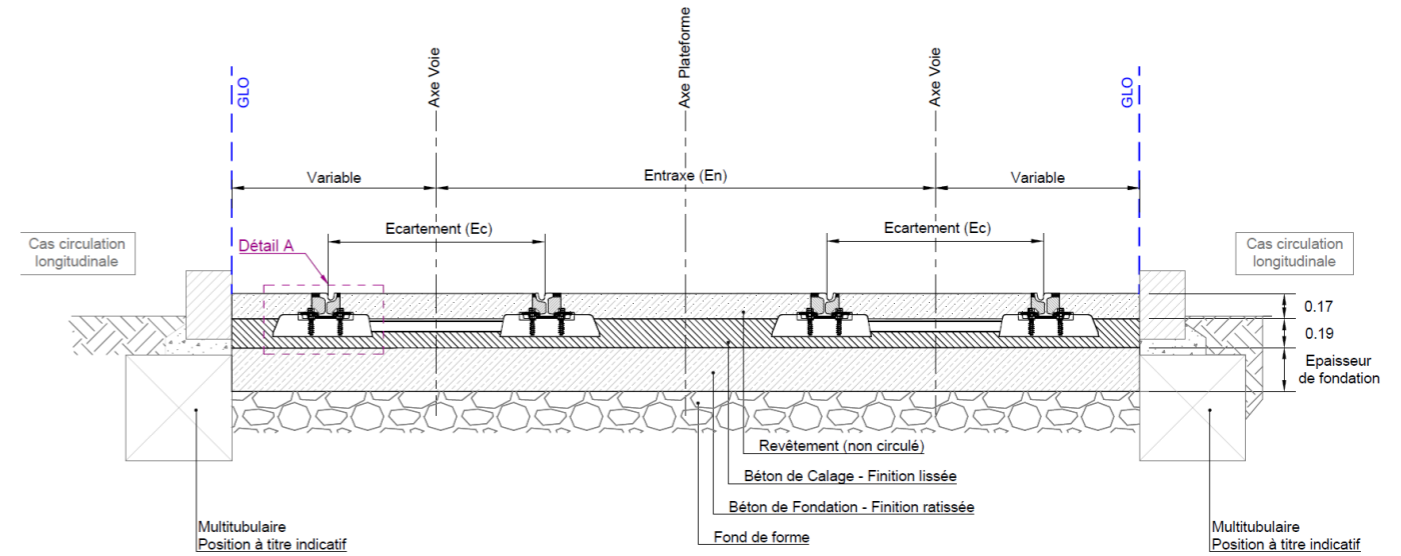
coupe type d'une plateforme - Voie béton traverses – Revêtement minéral circulé carrefour
